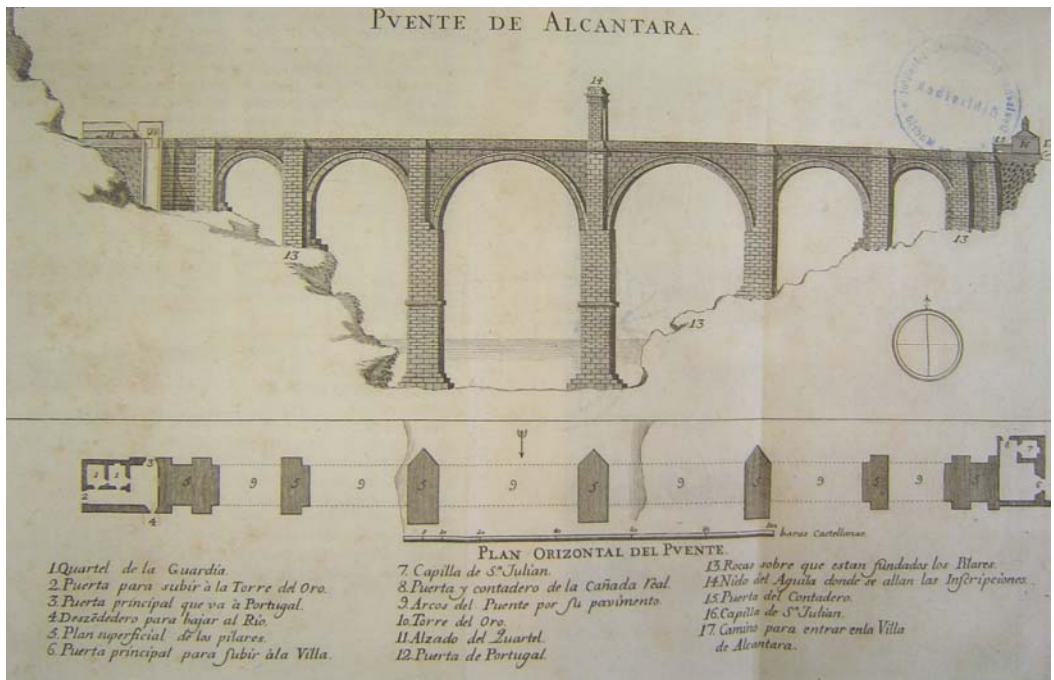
Alzado y plata del Puente de Alcántara (Cáceres).
